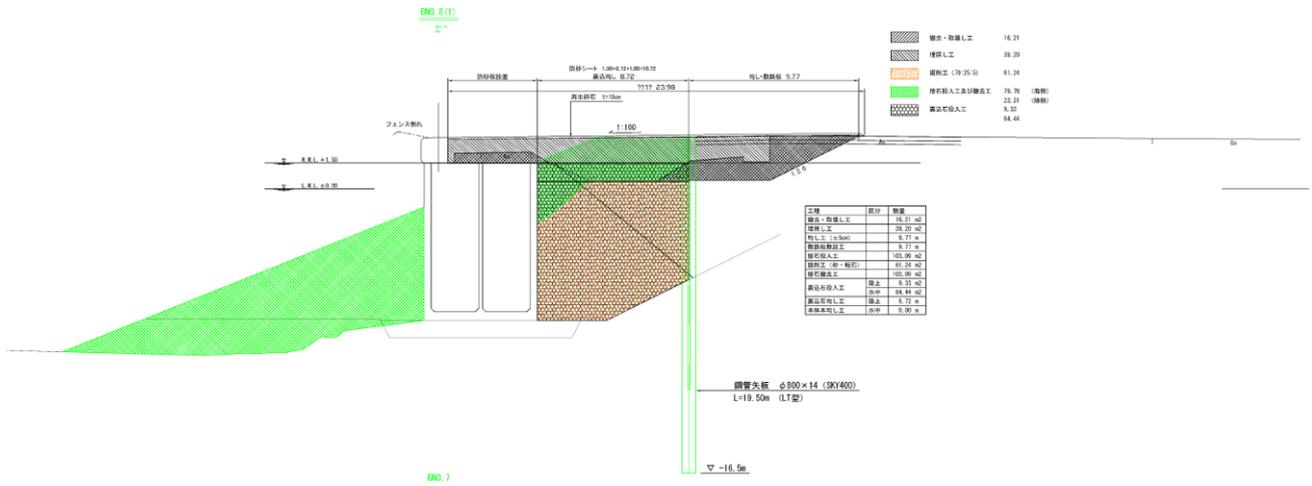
No.6 日立港区_第2ふ頭地区 2-C 岸壁 (-7.5m) の断面図 (復旧後)
